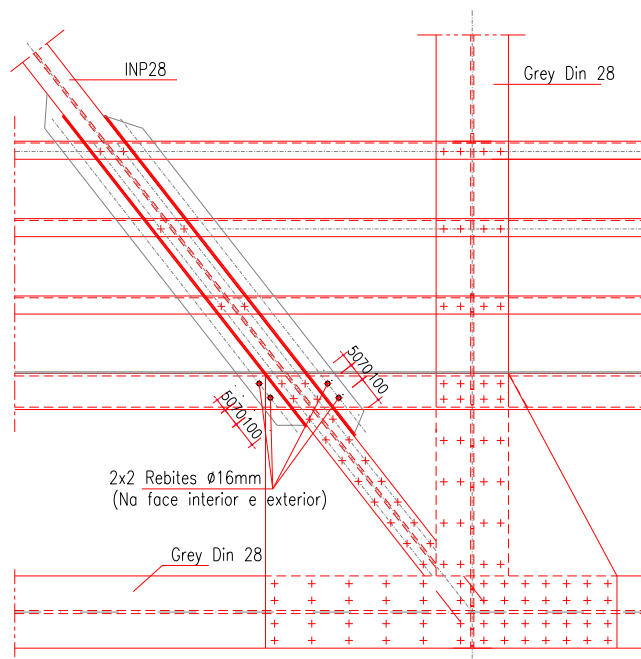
Reforço das ligações inferiores das diagonais do 3º Módulo (Fonte: Estradas de Portugal)
